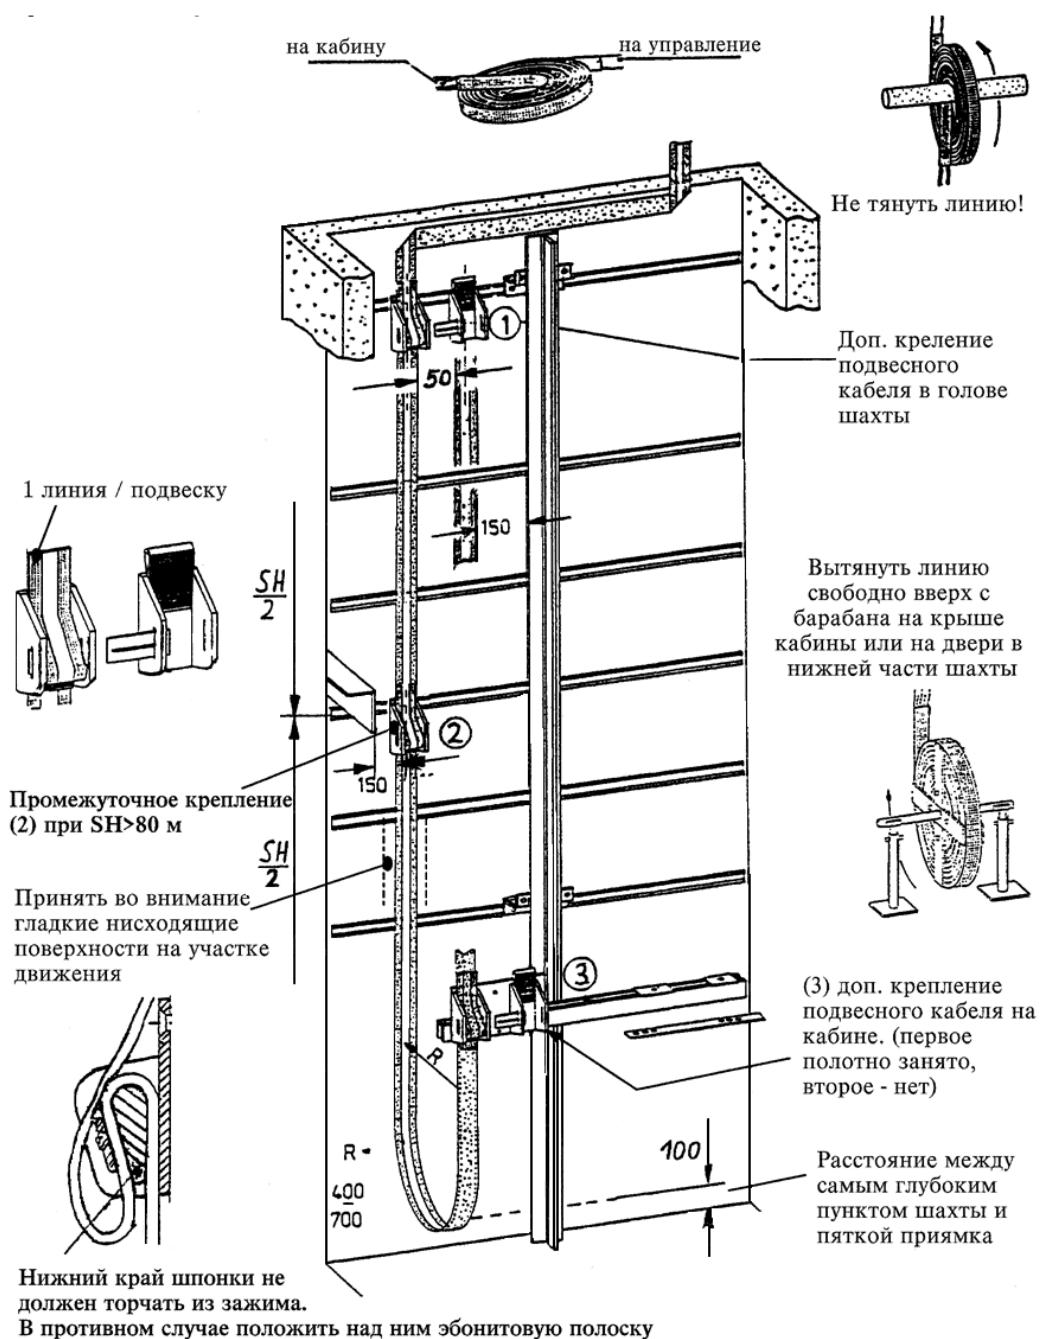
«Крепление плоского подвесного кабеля с армированием»
